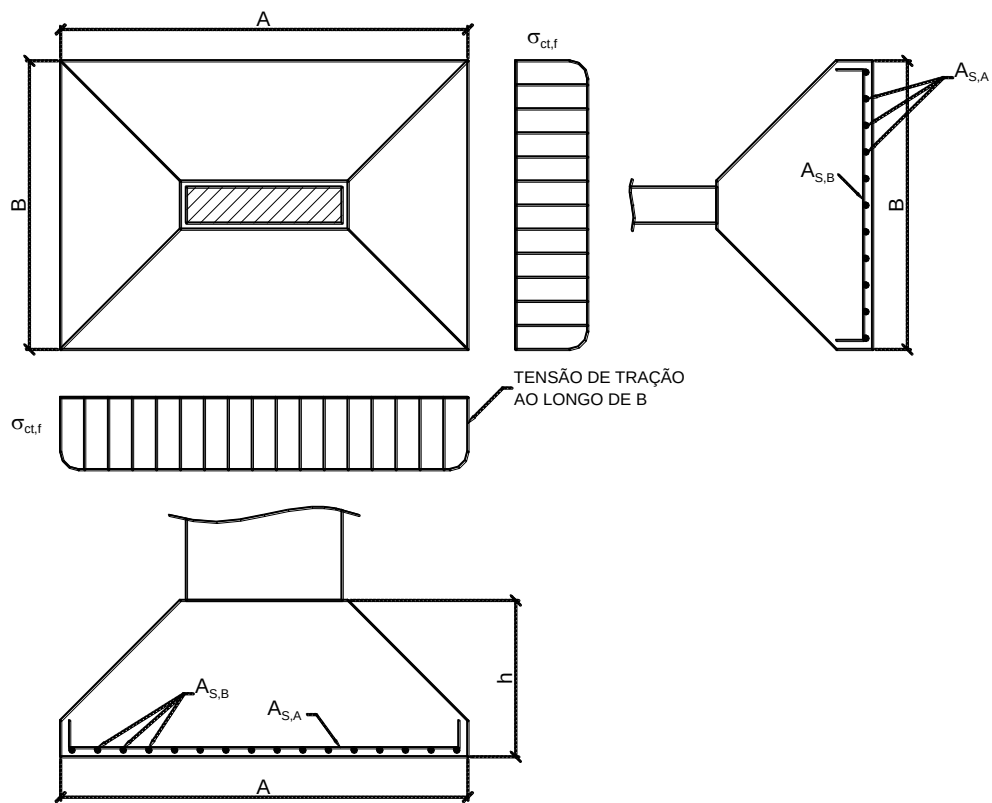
Armaduras positivas de flexão de sapatas isoladas, com $A_{s,A}$ paralela ao lado de dimensão A, e $A_{s,B}$ paralela à dimensão B.
